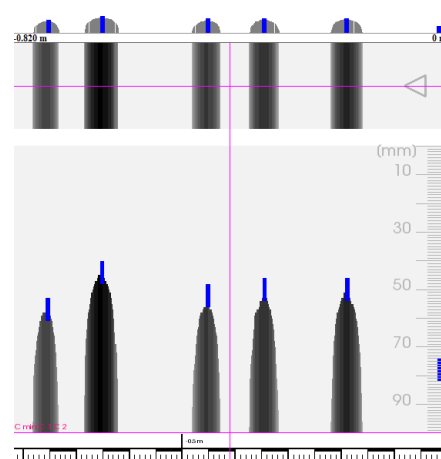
Poutre Pt02 – Travée 3 côté P2
